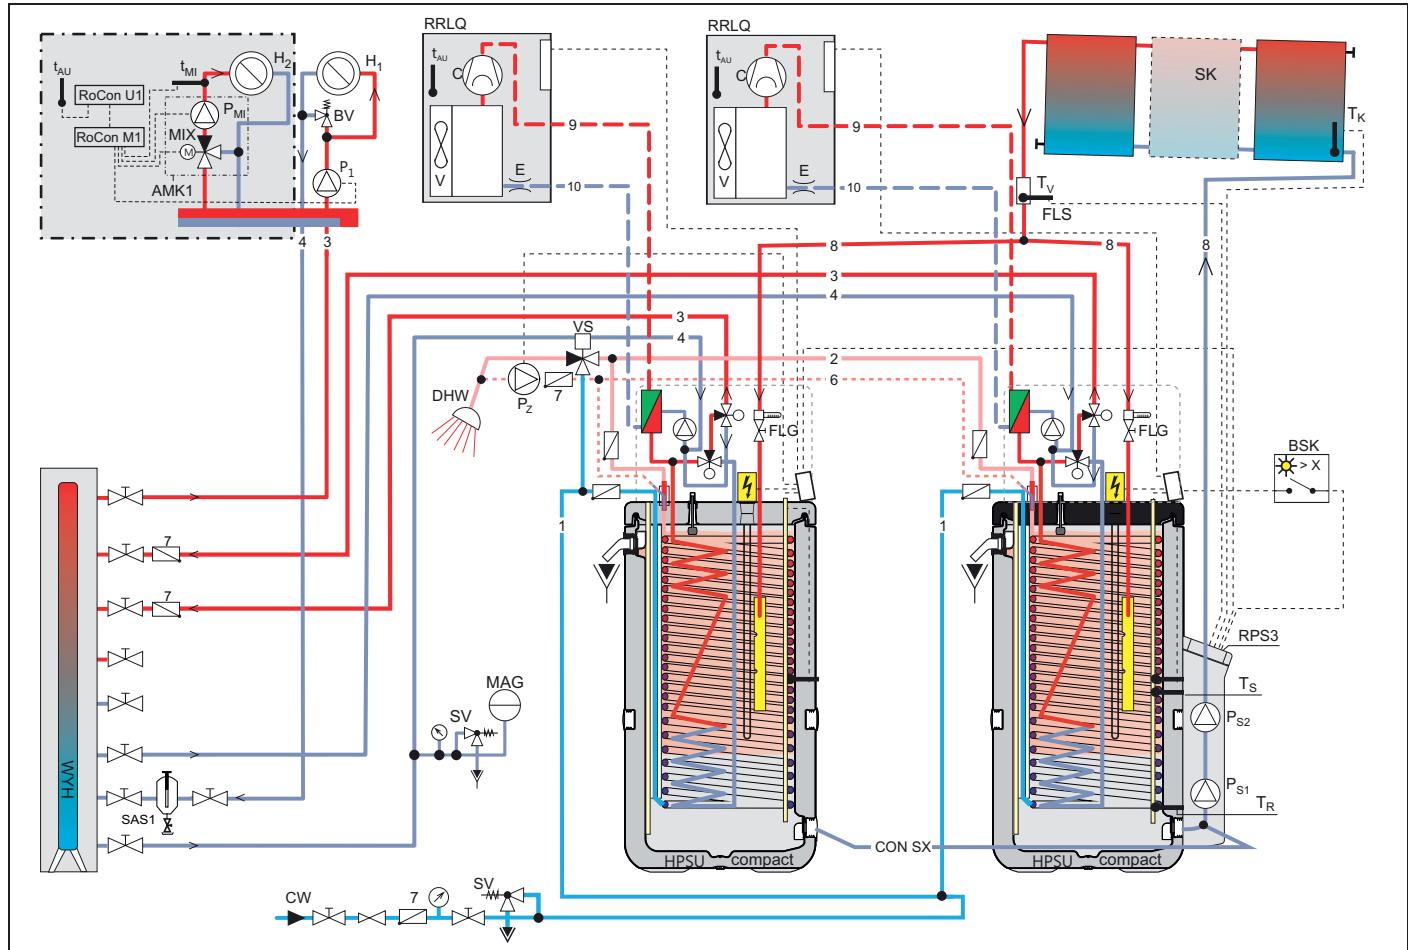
2x HPSU compact (alle Typen) in Kaskadenschaltung mit DrainBack Solaranlage - Parallelbetrieb i
